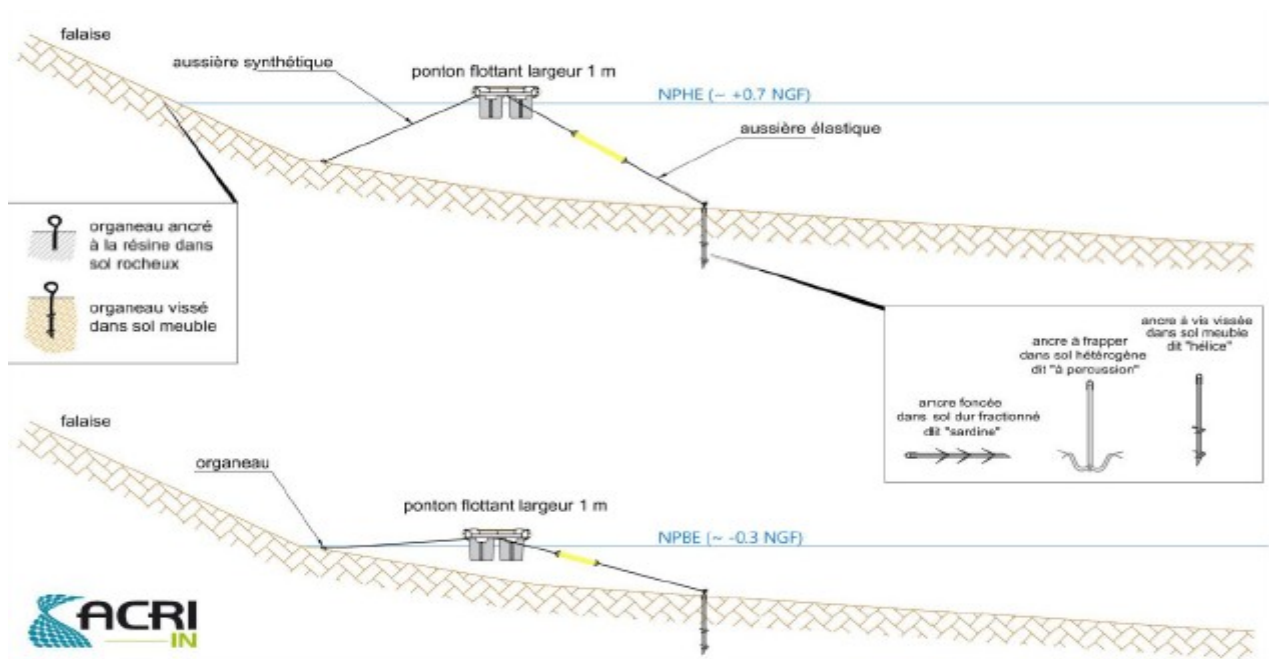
Plan de coupe d'ancrage des pontons flottants de la ZMEL (source : p.45 de la pièce 2)
